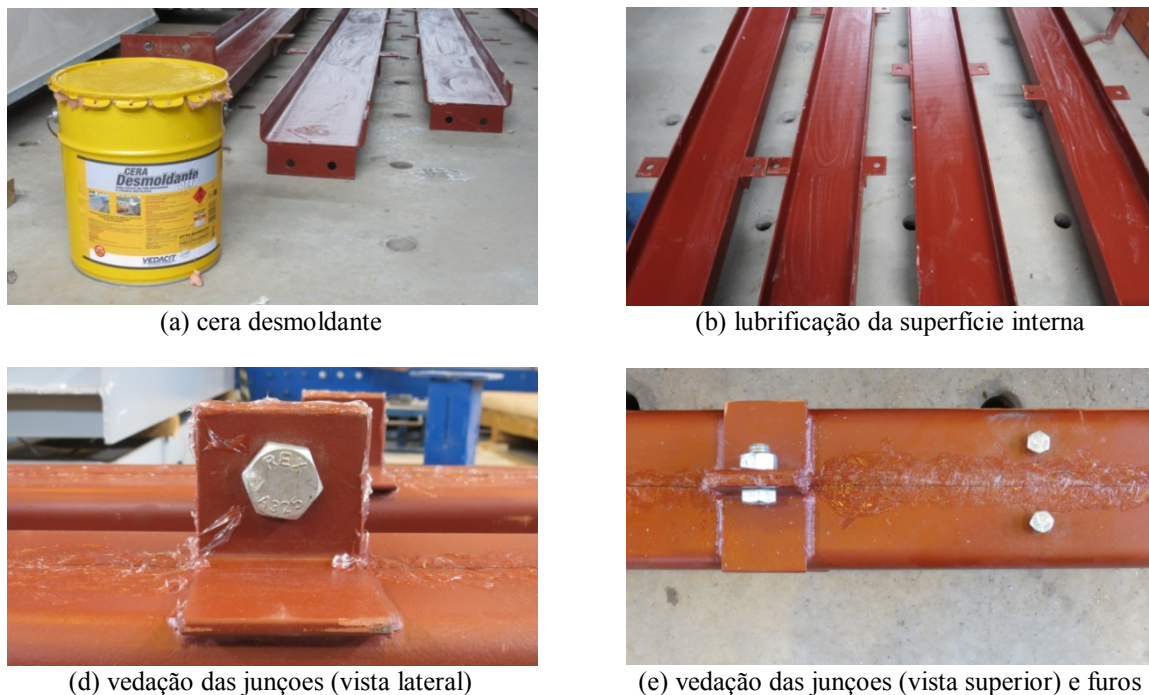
Ensaios de concretagem: preparação dos tubos de aço
